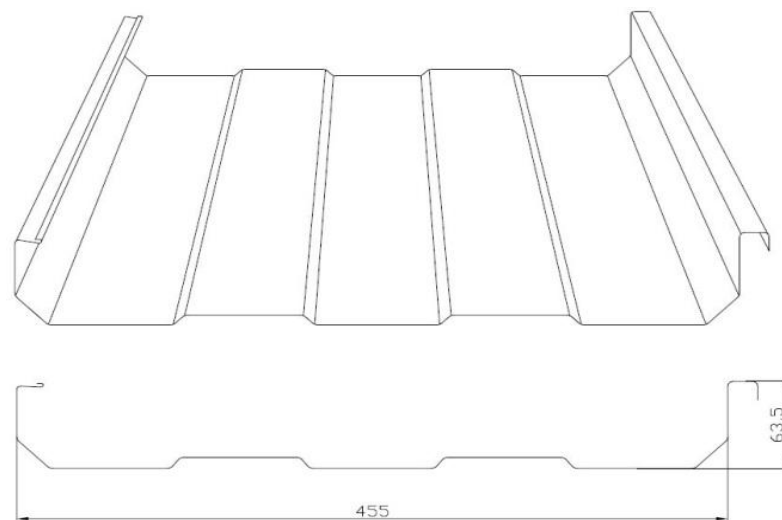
Desenho técnico do perfil RW 65 (Roofway, 2010).
